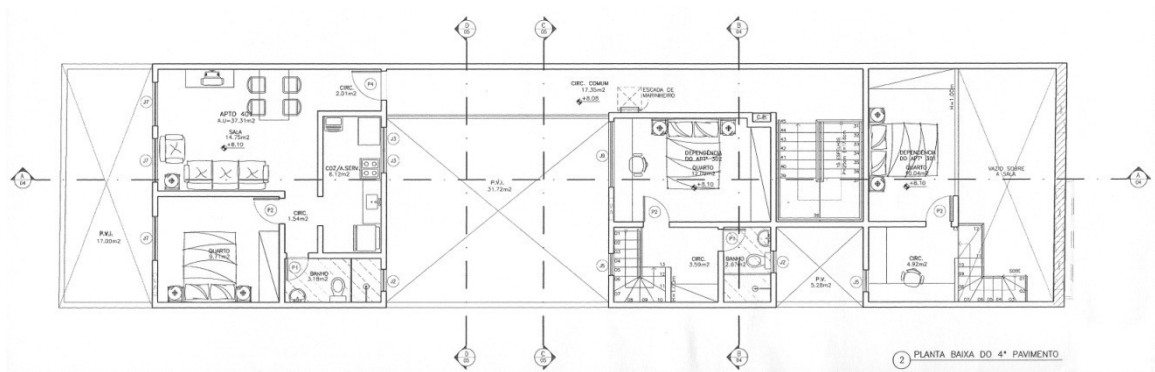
Planta de layout do 4º pavimento do empreendimento João Álvares 18.
